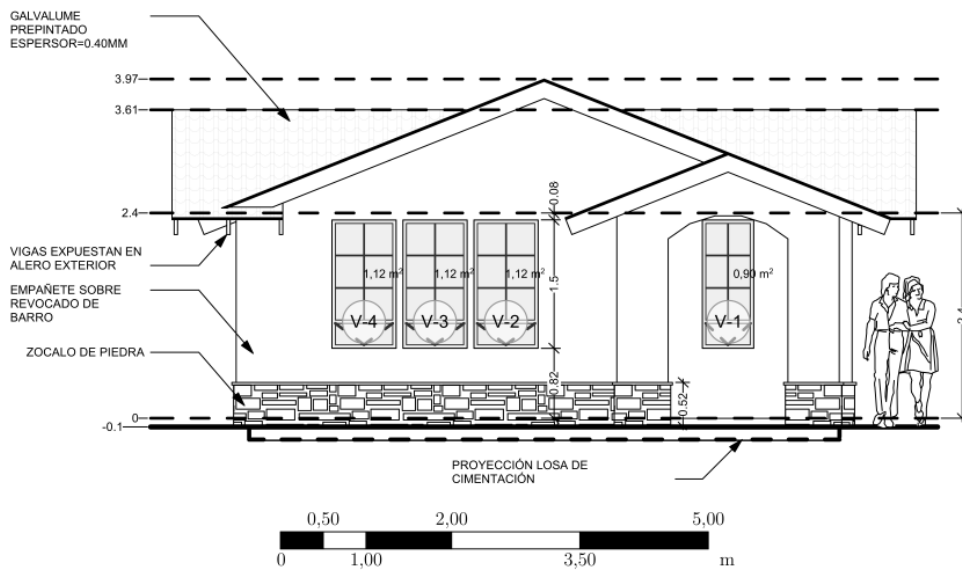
Elevación Frontal (Nor-Este) del proyecto para Sr. Gerardo Campoverde.
